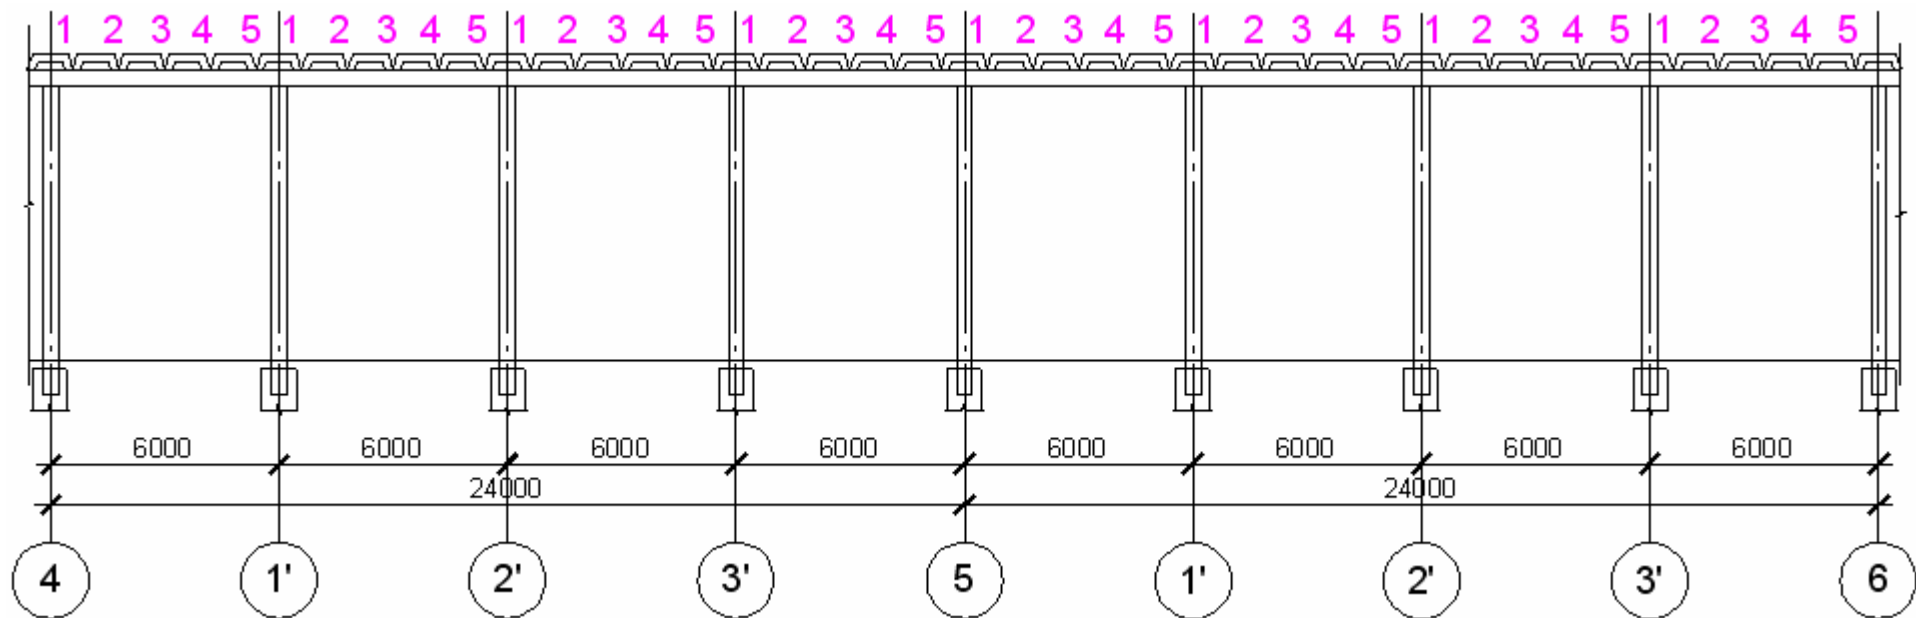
Схема номерации плит перекрытия на отметке +1,2м.
